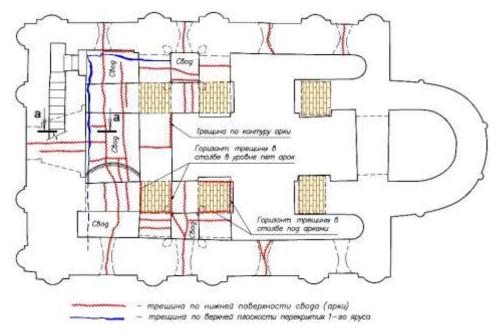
Схема трещин по сводам и аркам перекрытия 1-го яруса
